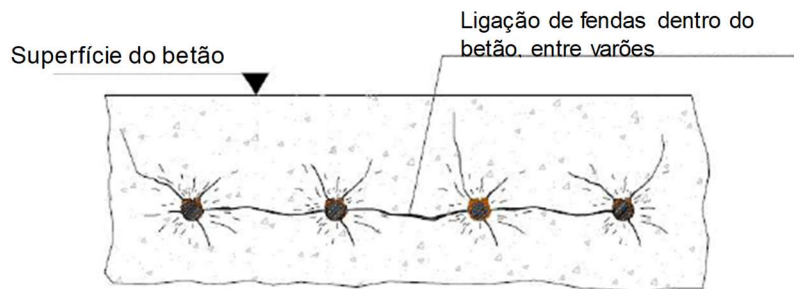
Fissuras laterais no betão criadas entre varões. (Adaptado de (Pina, 2009)).
